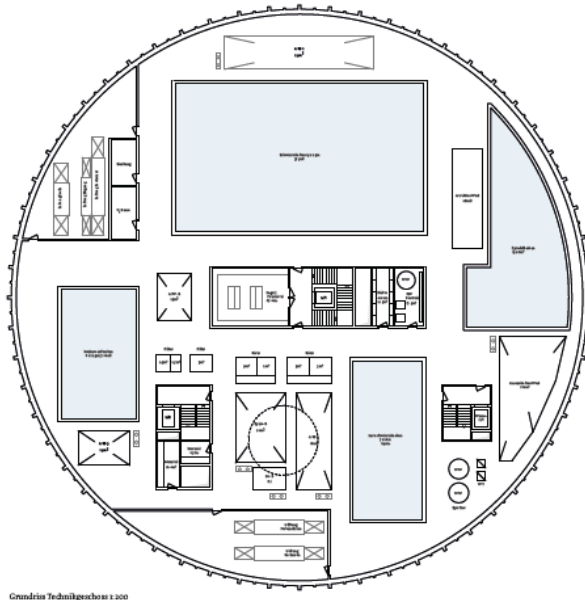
Grundriss Technikgeschoss (ohne Masstab)
